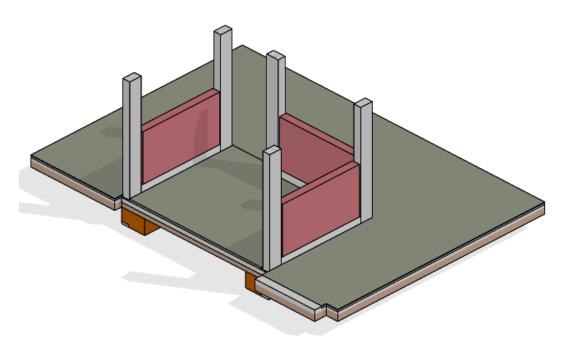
Modelo BIM, Vista en Planta del Primer Nivel de Área de Almacén.
